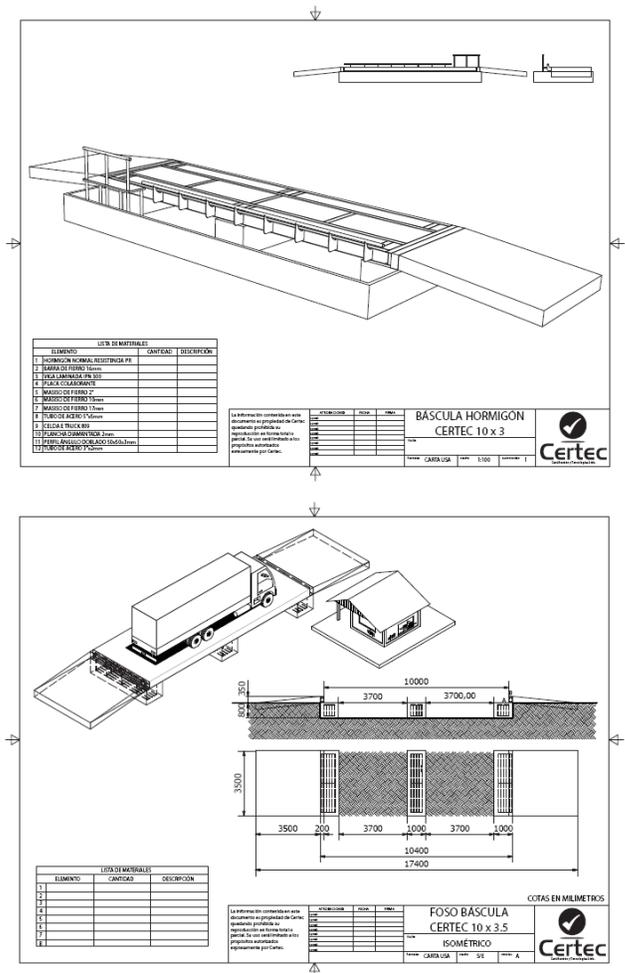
y 31: Planimetrías Báscula y Foso Certec. Elaboración propia.
